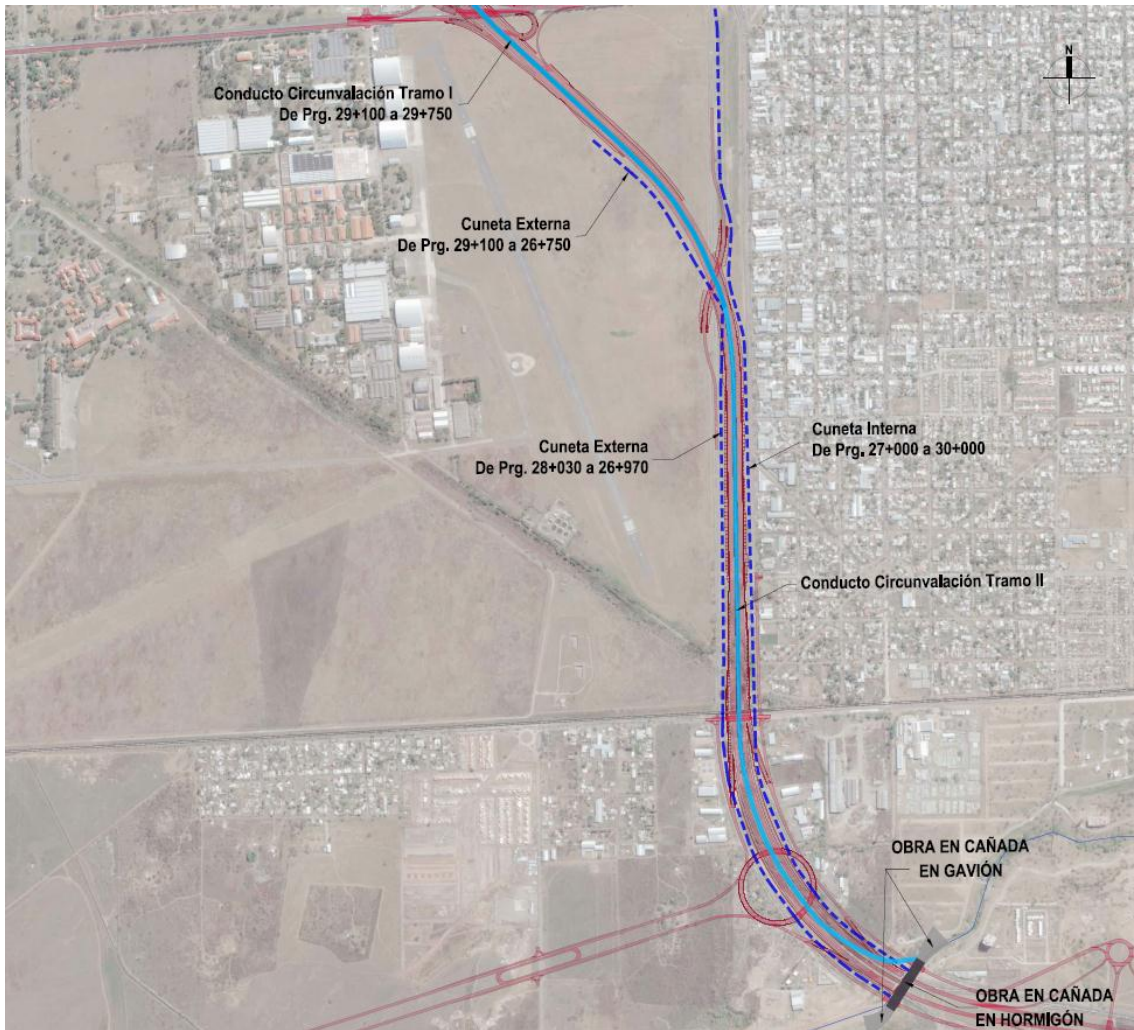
Planimetría general del sistema de drenaje Sección 1.
